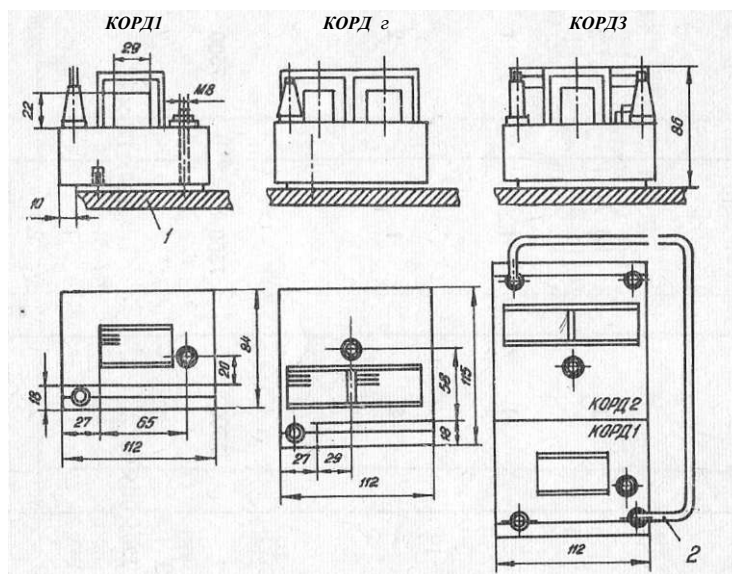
Габаритные и установочные размеры аппаратов КОРД:
